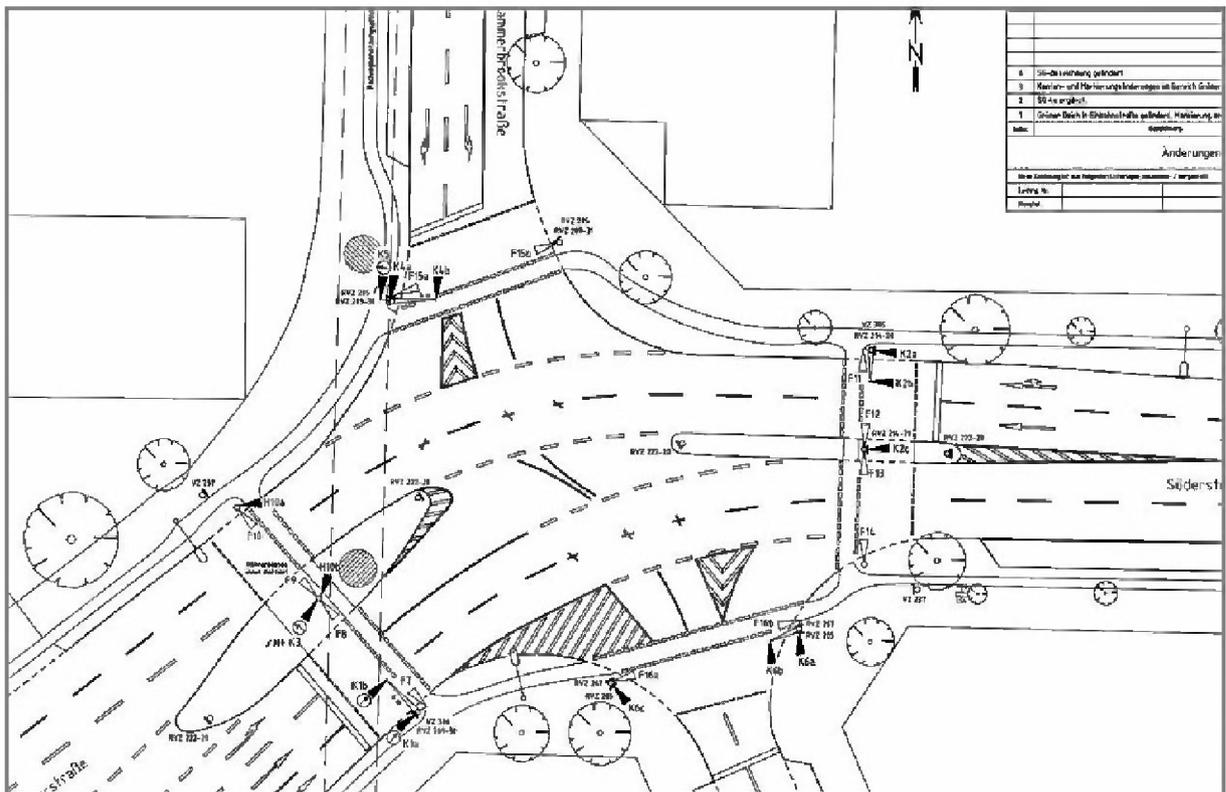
2 Signallageplanausschnitt LSA 1689
